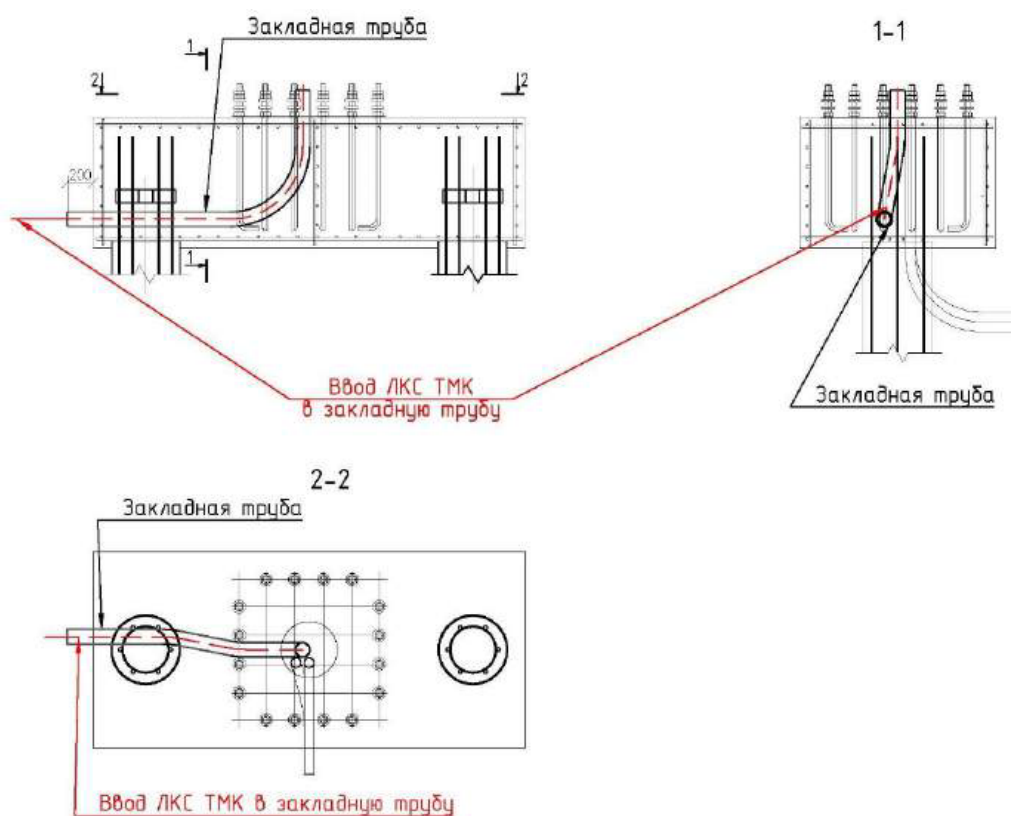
Схема ввода ЛКС ТМК в фундамент П-образной опоры
